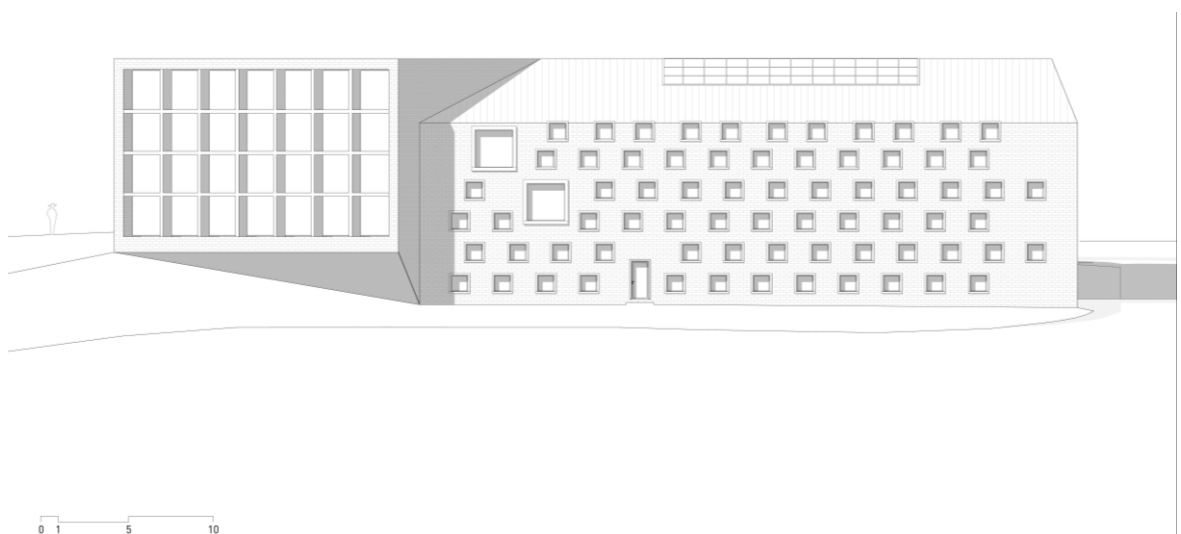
Фасад будівлі[<https://drozdov-partners.com/projects/yeshiva/>]
